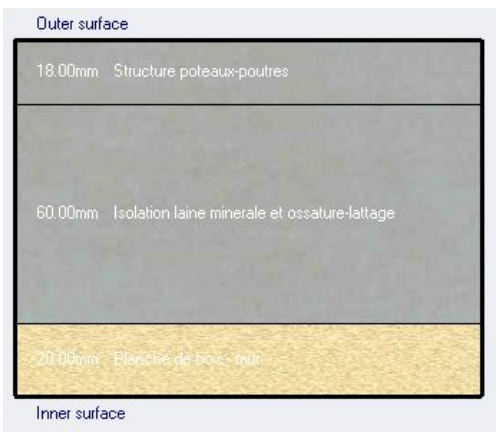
DesignBuilder - Construction - Murs Intérieurs – Illustration
